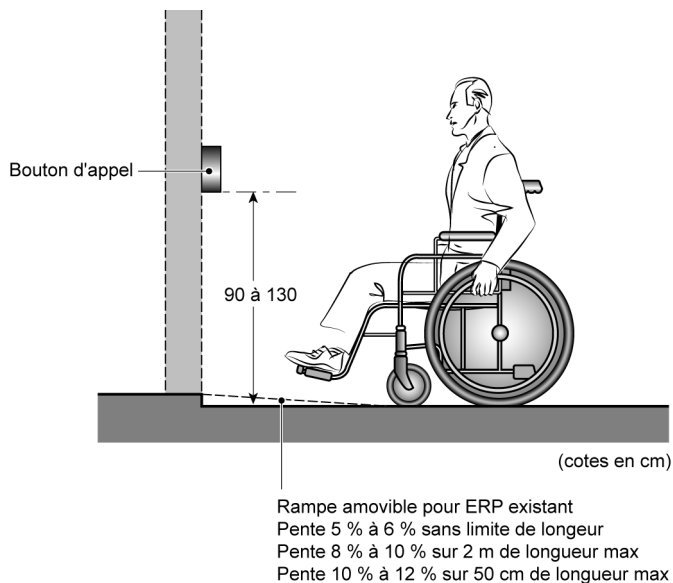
Rampe d'accès et bouton d'appel
